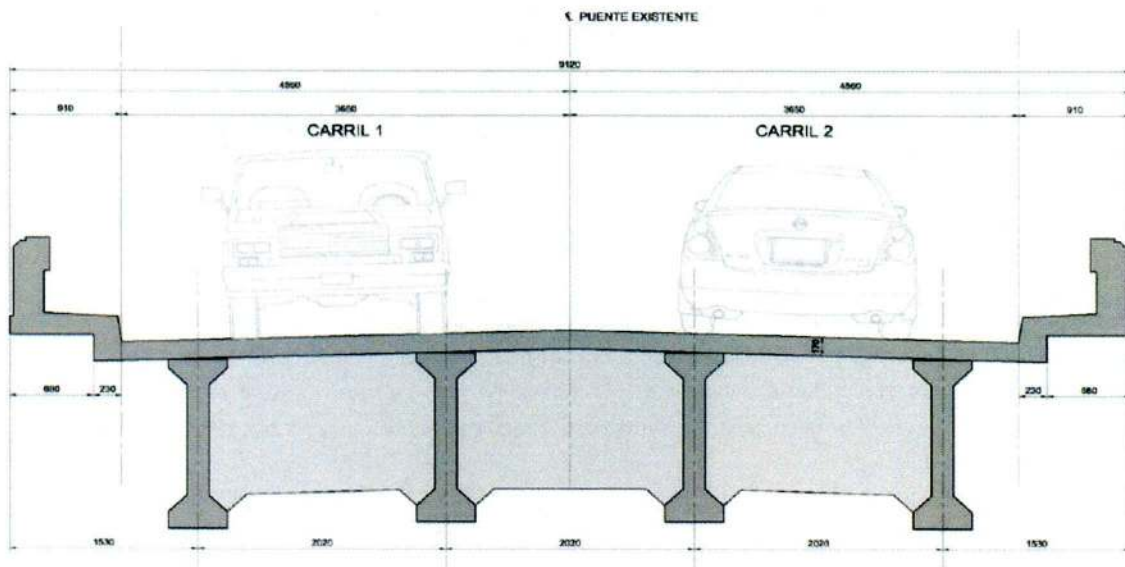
Sección transversal puente existente sobre el río Corrogres
